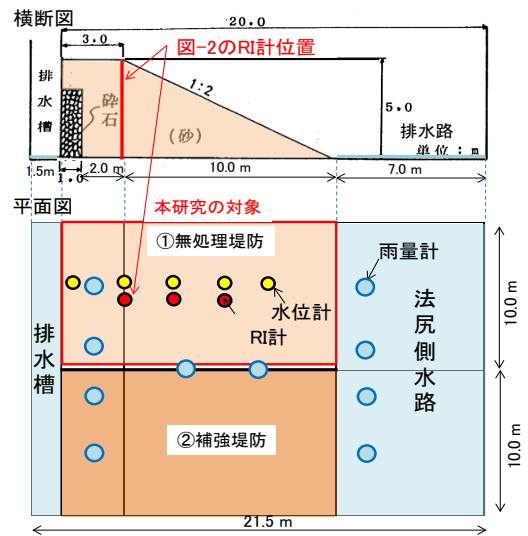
土木研究所⁴⁾の模型大型堤防実験装置 (上: 横断面図, C: 平面図)
